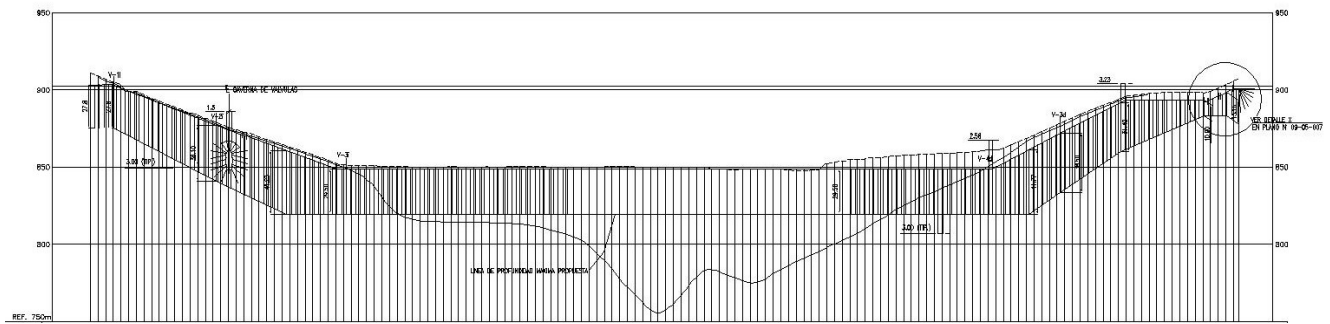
Perfil longitudinal por eje de cortina de inyecciones de impermeabilización
